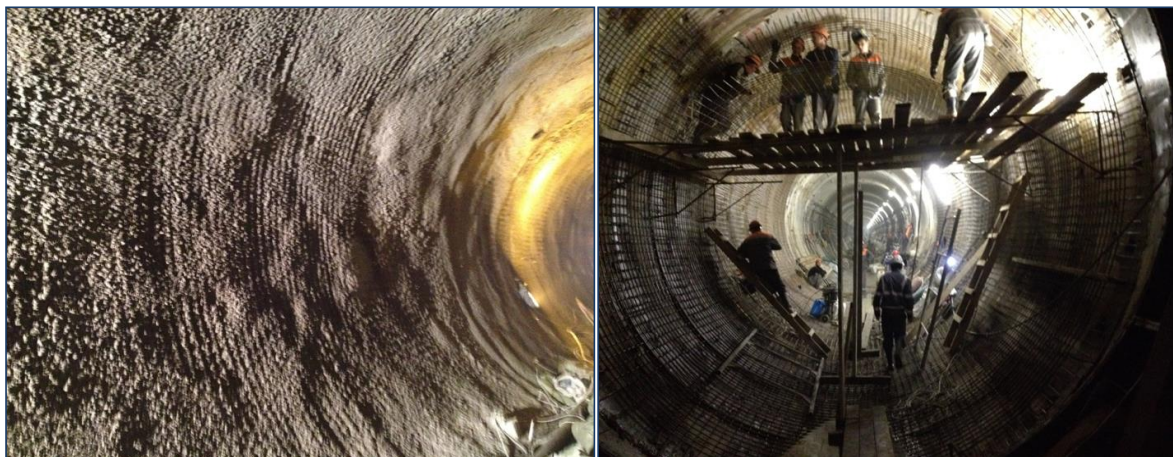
Расчетная схема усиления дефектного участка тоннеля фибронабрызгбетоном с армированием
